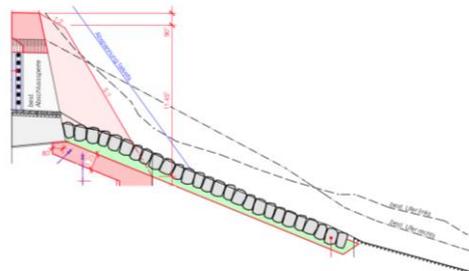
Protection contre l'affouillement en pierres en aval d'un barrage (source : Geschiebesammler Gryfenbach Vergrößerung Rückhaltevolumen, Flussbau AG SAH & Mätzener und Wyss Bauingenieure AG, 2010).
